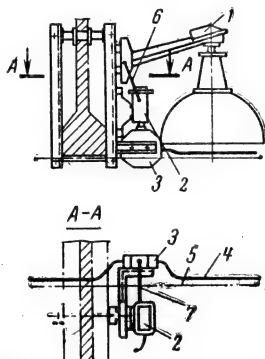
Установка светильника с лампой ДРЛ на кронштейне У114 на ферме.
